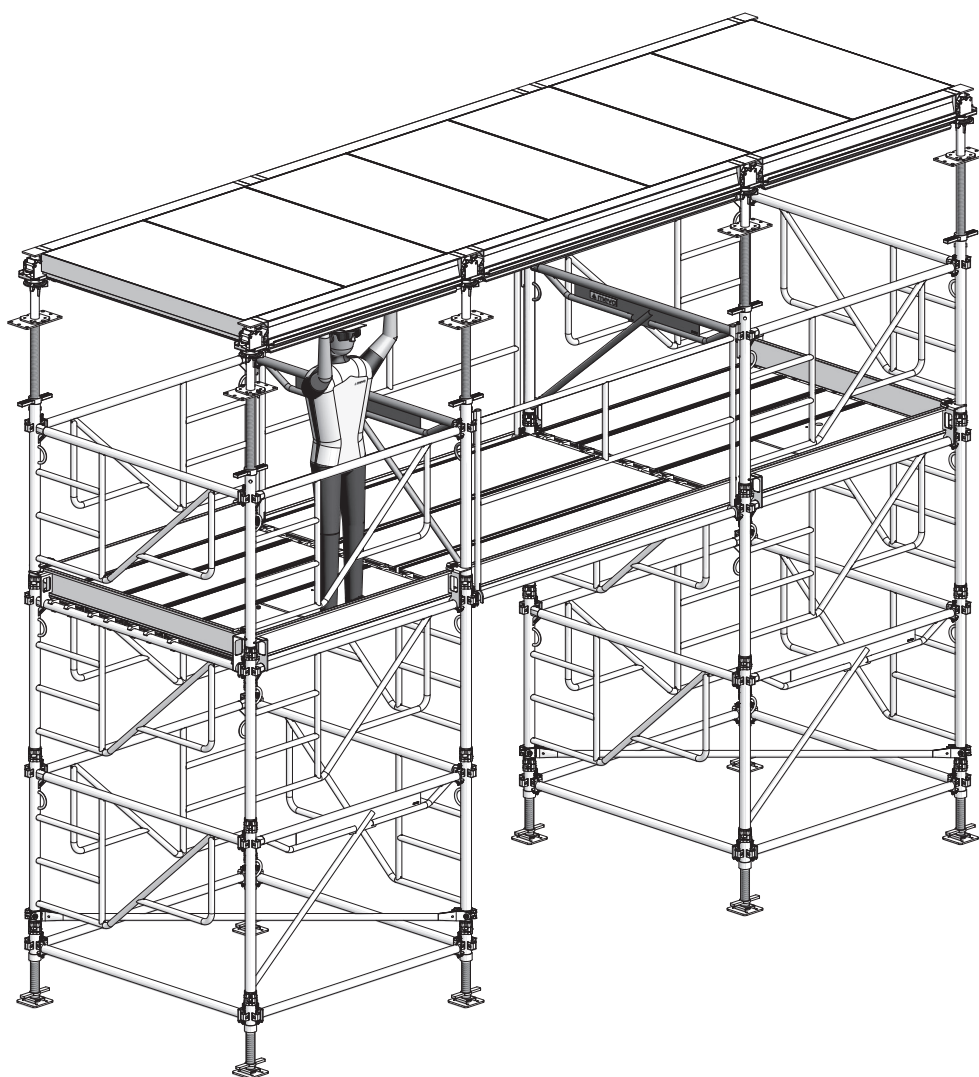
Tours étayant le coffrage de dalles MevaDec
